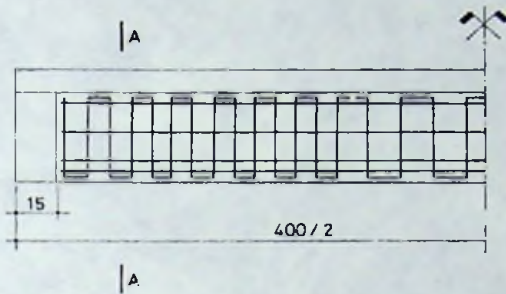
Consolidarea unei grinzi prin placare cu beton armat la imobilul din București, Bd. Dacia 58: 1 — strat de rășină epoxidică; 2 — placare cu beton B 500.
